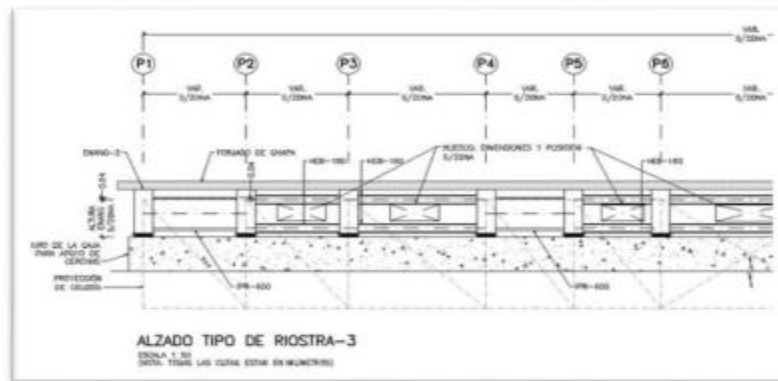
Alzado detalle tipo riostra cubierta Hospital de Toledo
